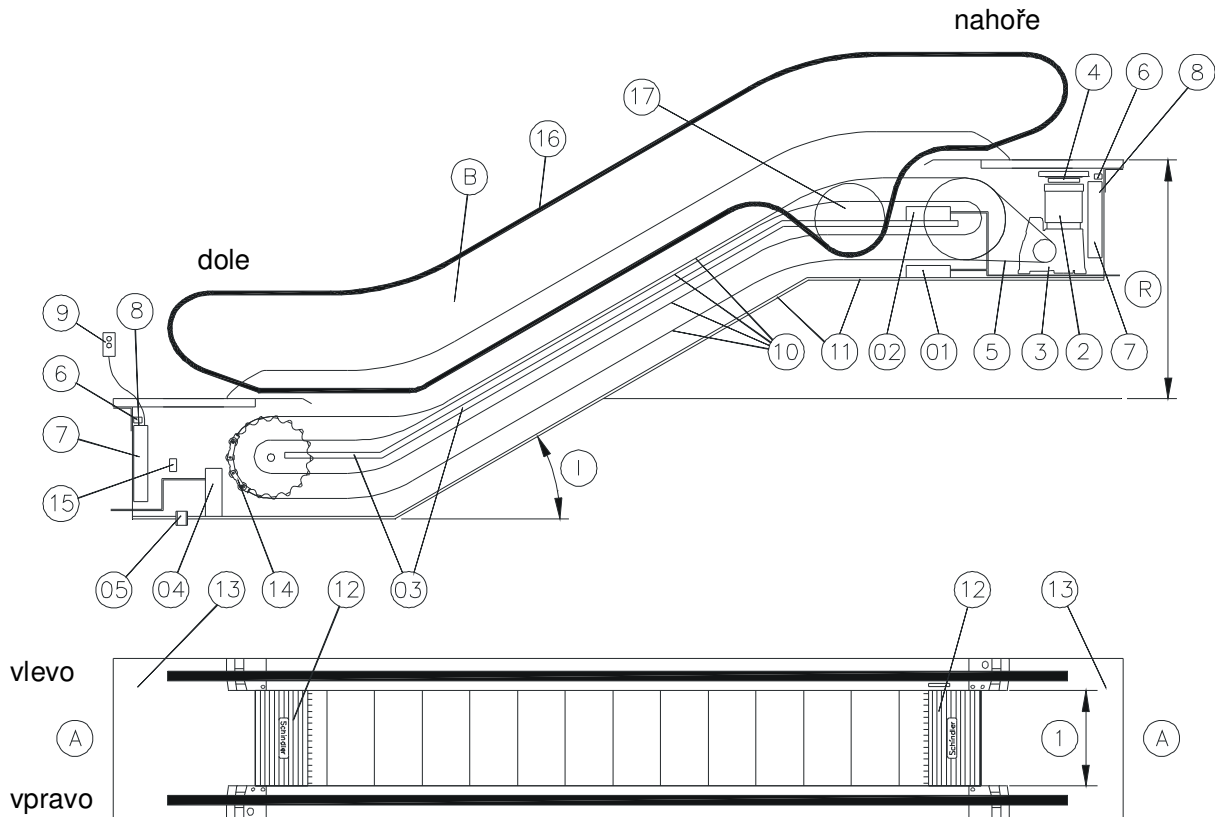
Přehledný náčrt eskalátoru Schindler 9300AE
